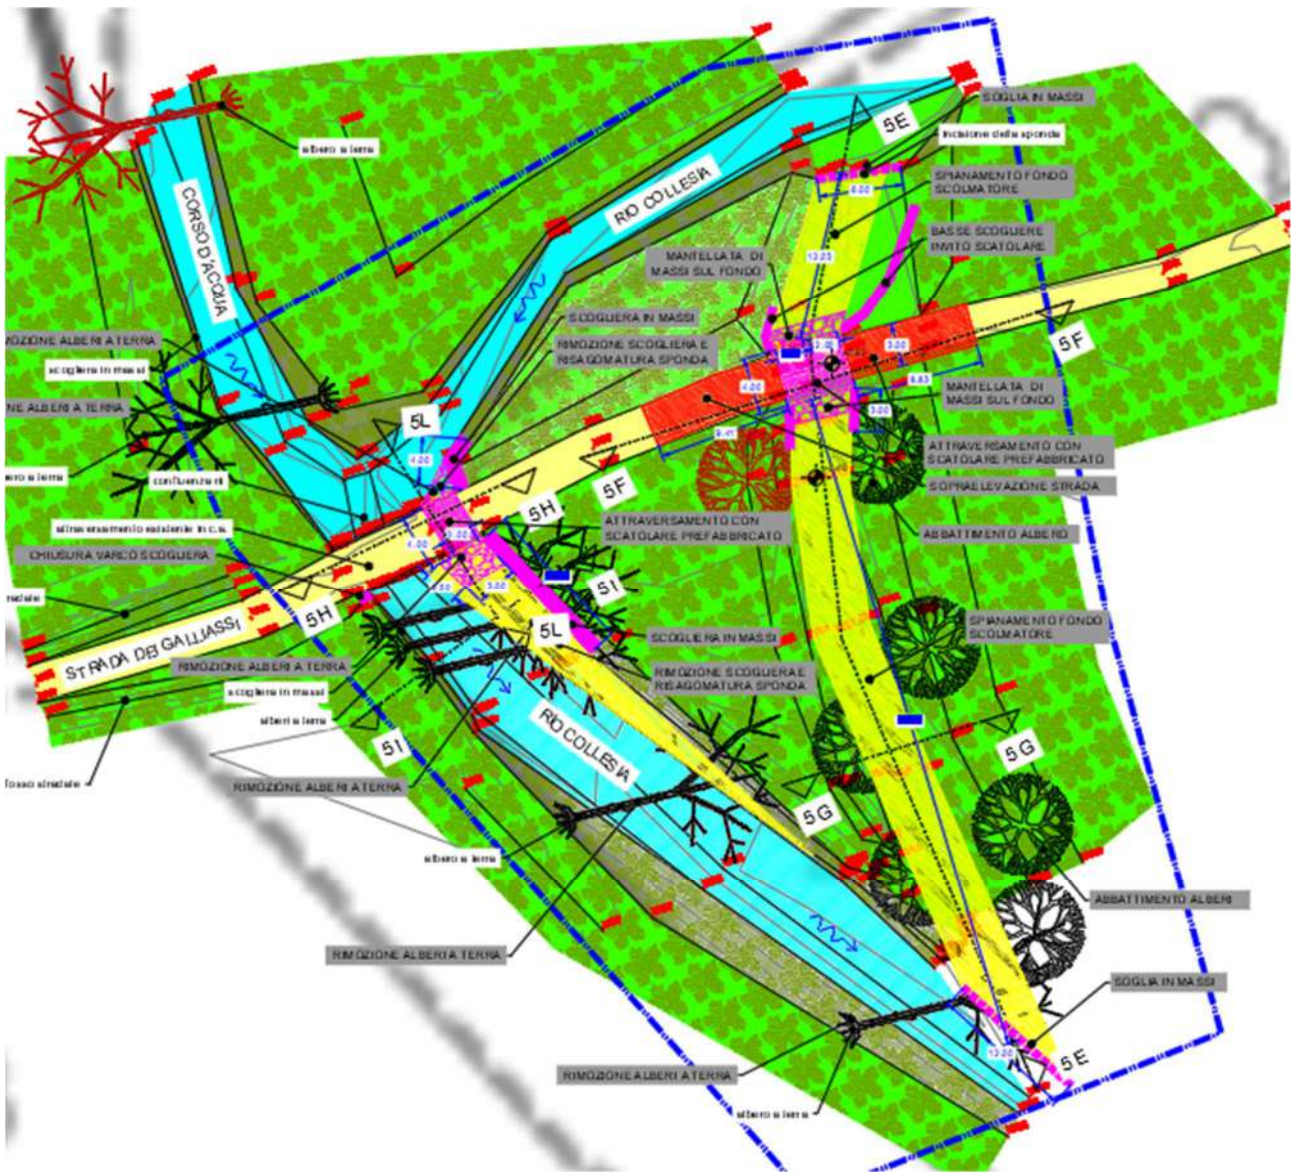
Planimetria di progetto. (rappresentazione non in scala)
